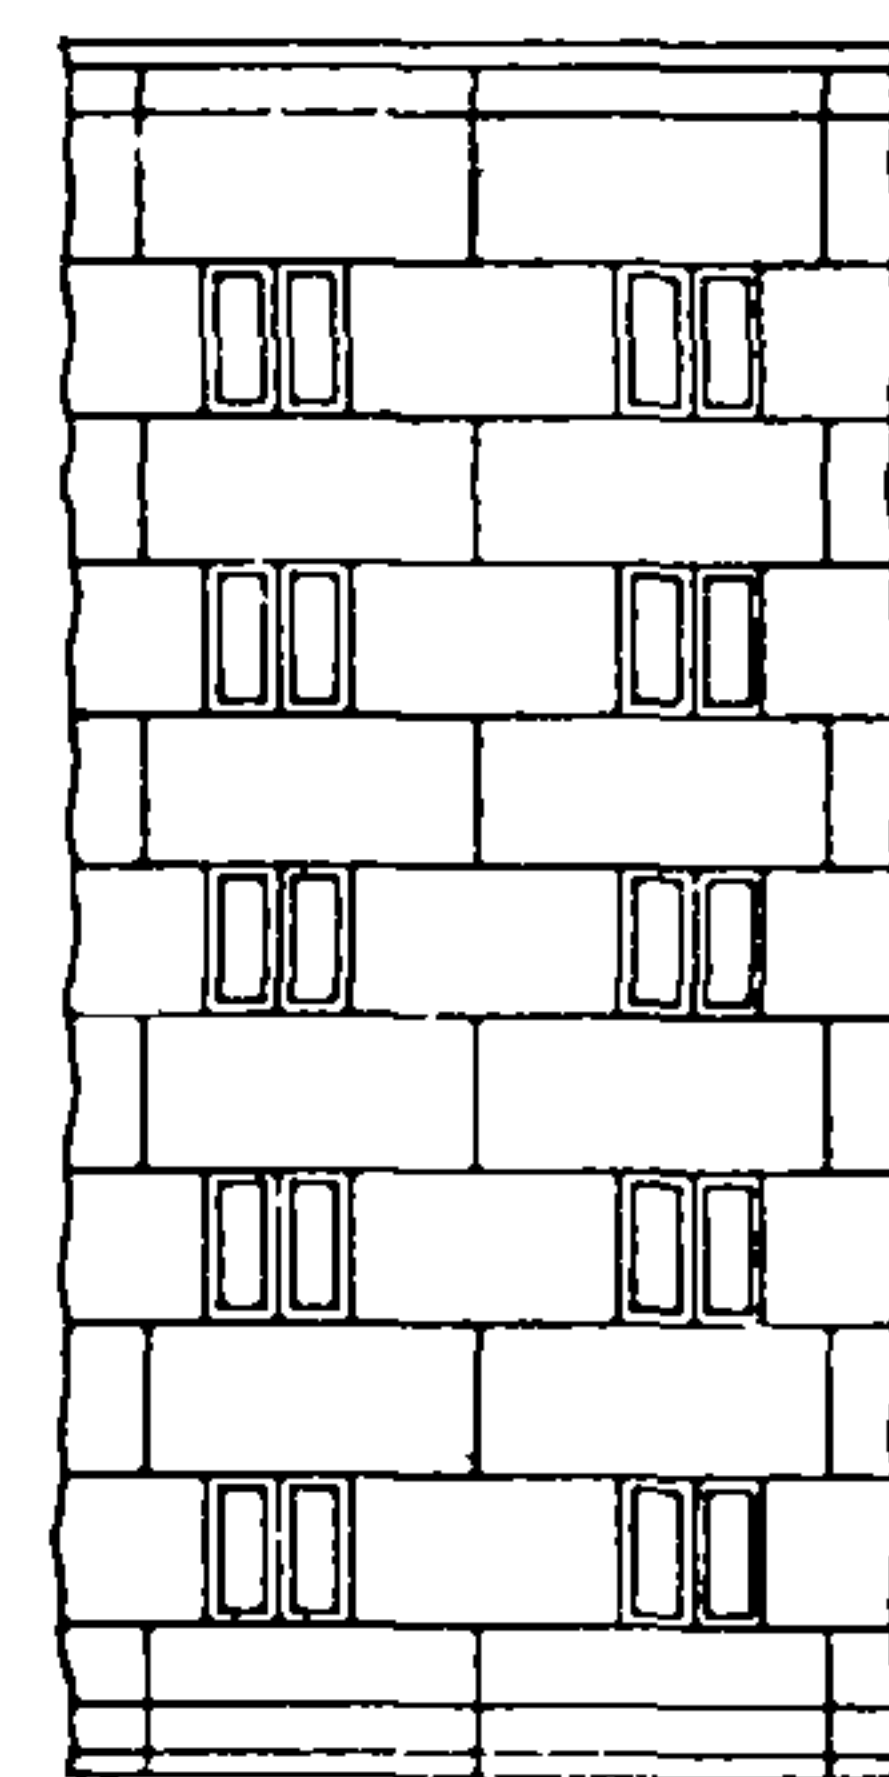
Фрагмент фасадной стены из крупных блоков при двухблочной (ленточной) разрезке
